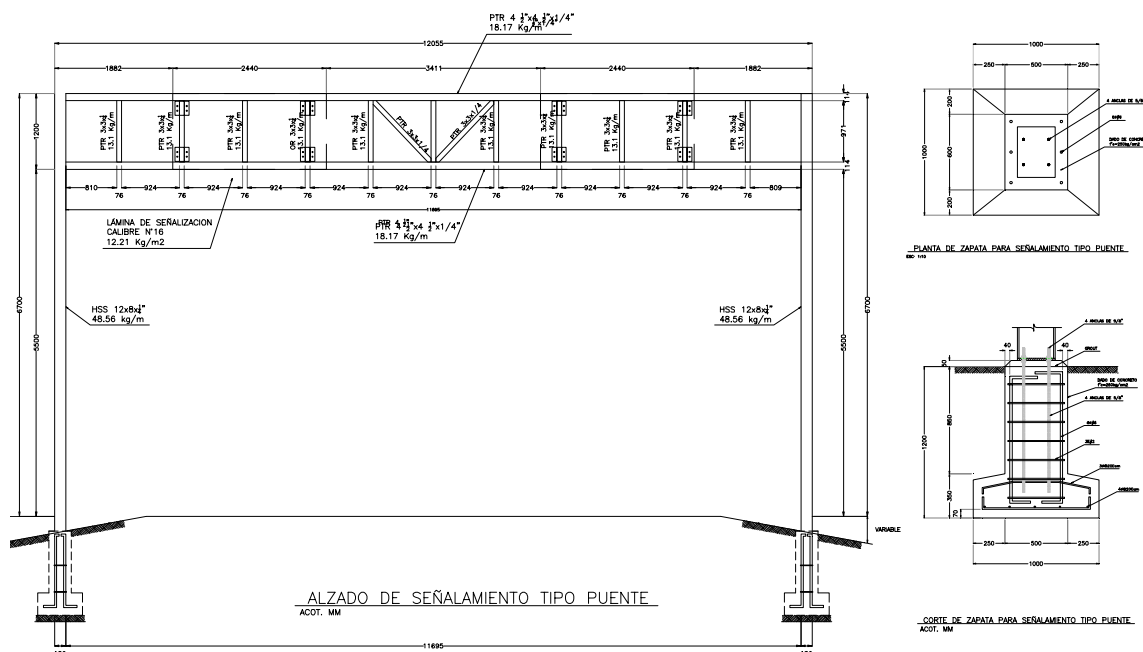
Detalles estructura de soporte de las Señales Elevadas SID-15
